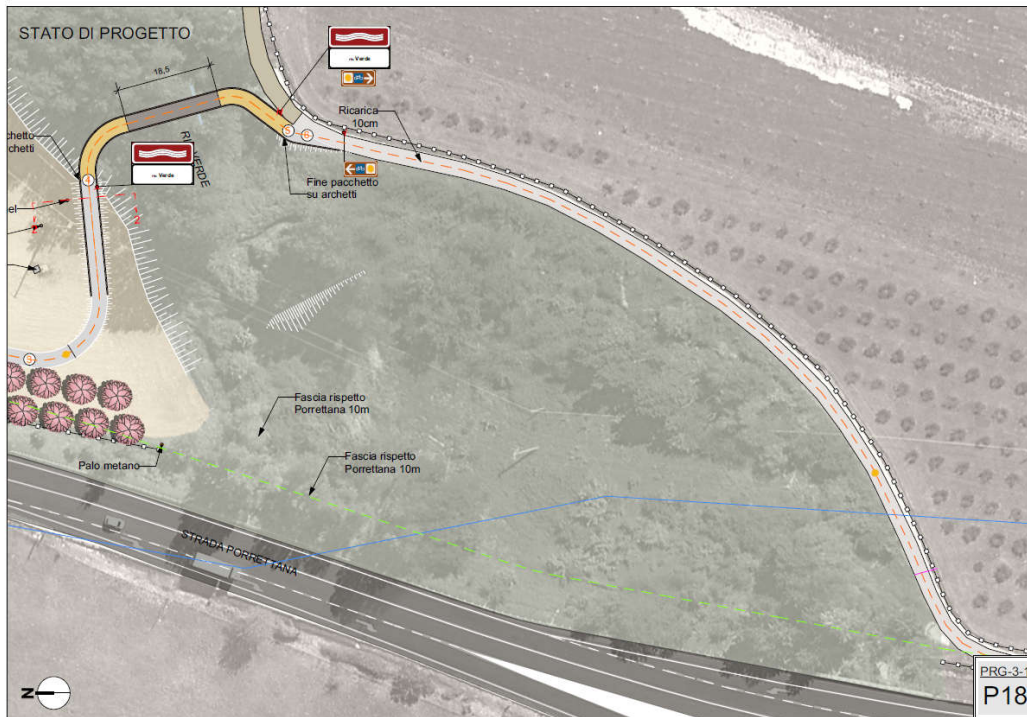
Fosso Rio Verdi – vista planimetrica della passerella in acciaio
